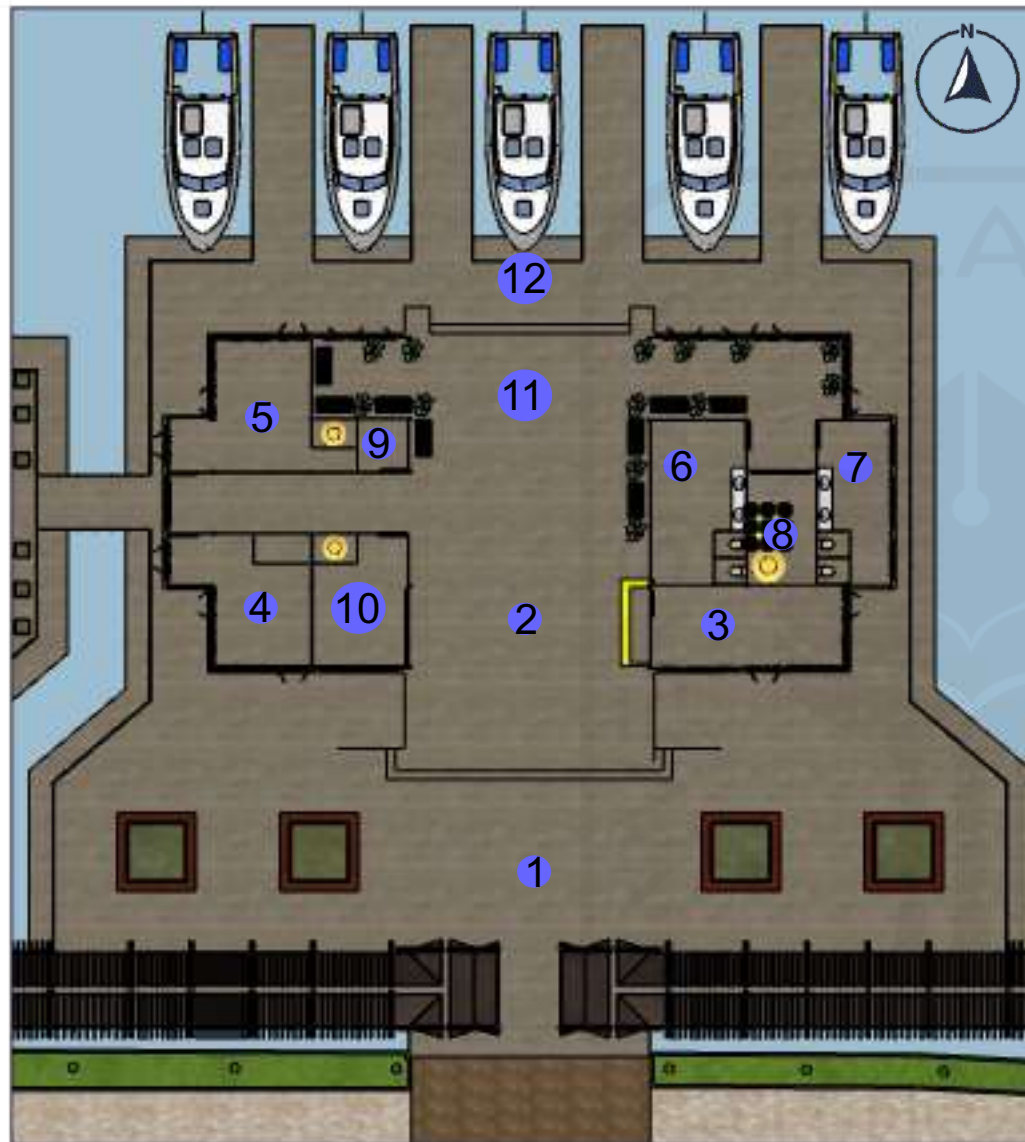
Siteplan Rest Area Apung Nanga Pinoh
